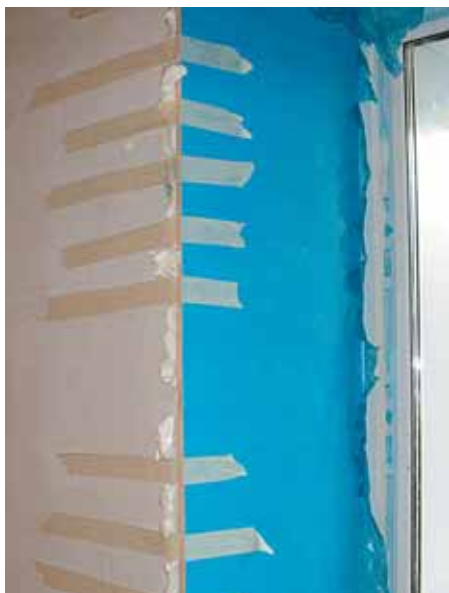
Крепление откоса к стене бумажной клейкой лентой
